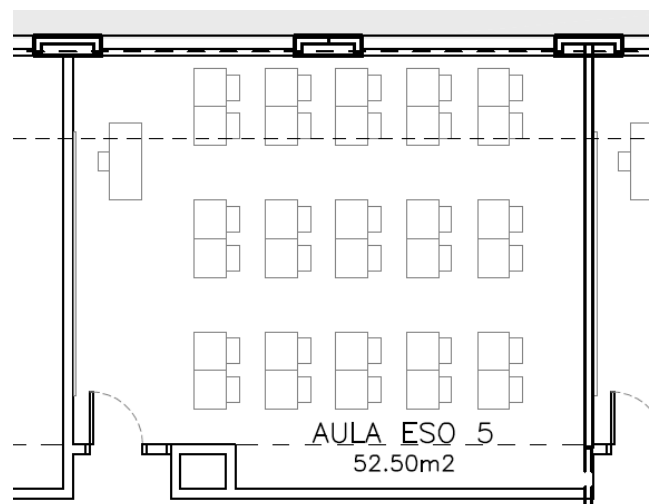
Planta del aula E.S.O. 5. Fachada norte. Fuente: Planos memoria proyecto.
